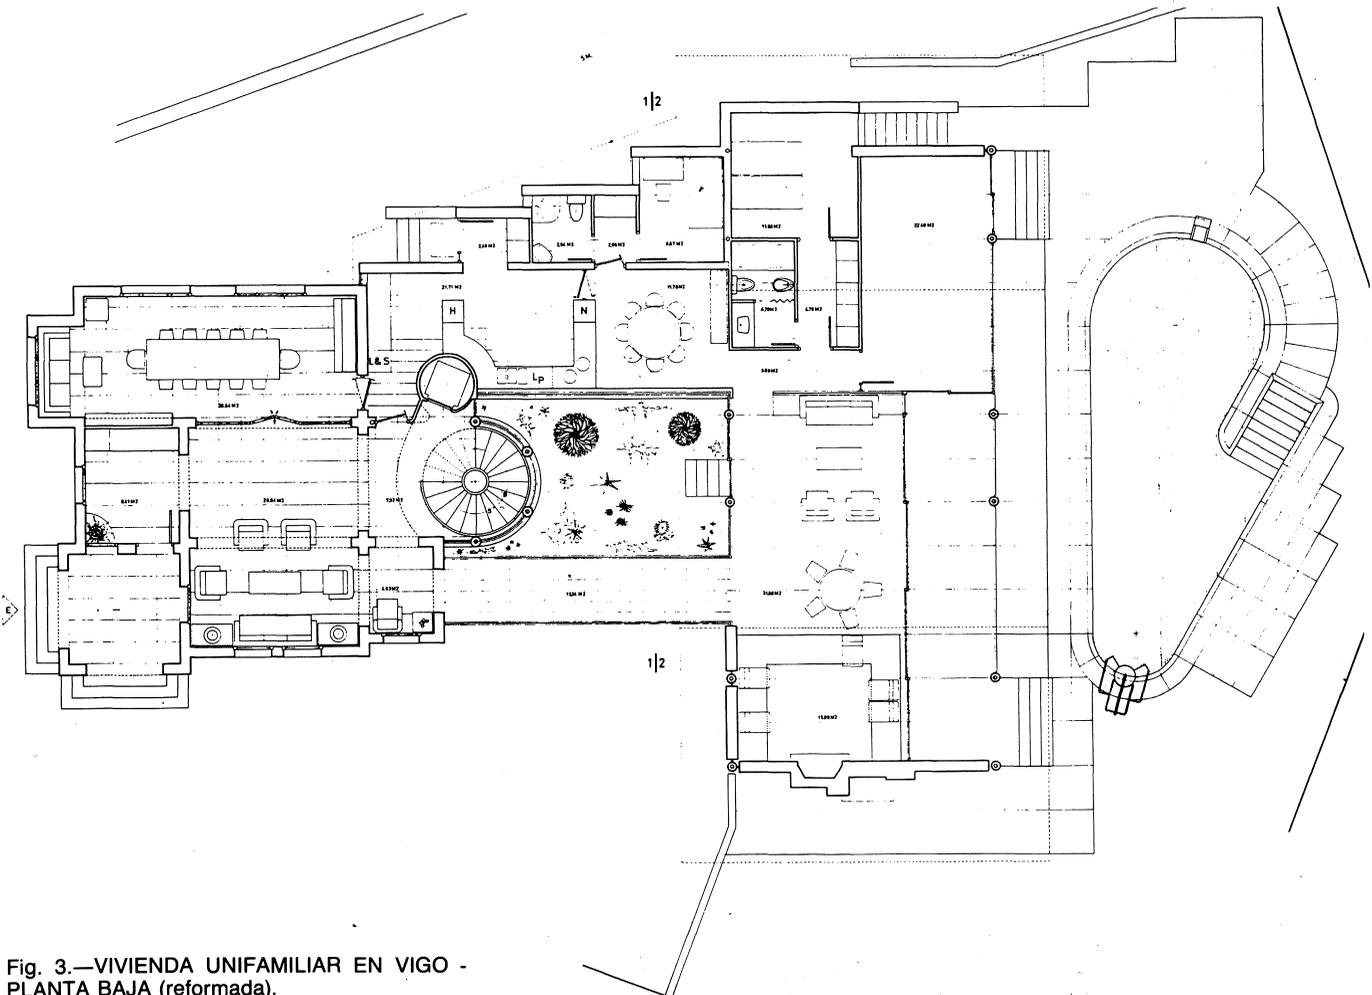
VIVIENDA UNIFAMILIAR EN VIGO - PLANTA BAJA (reformada).
